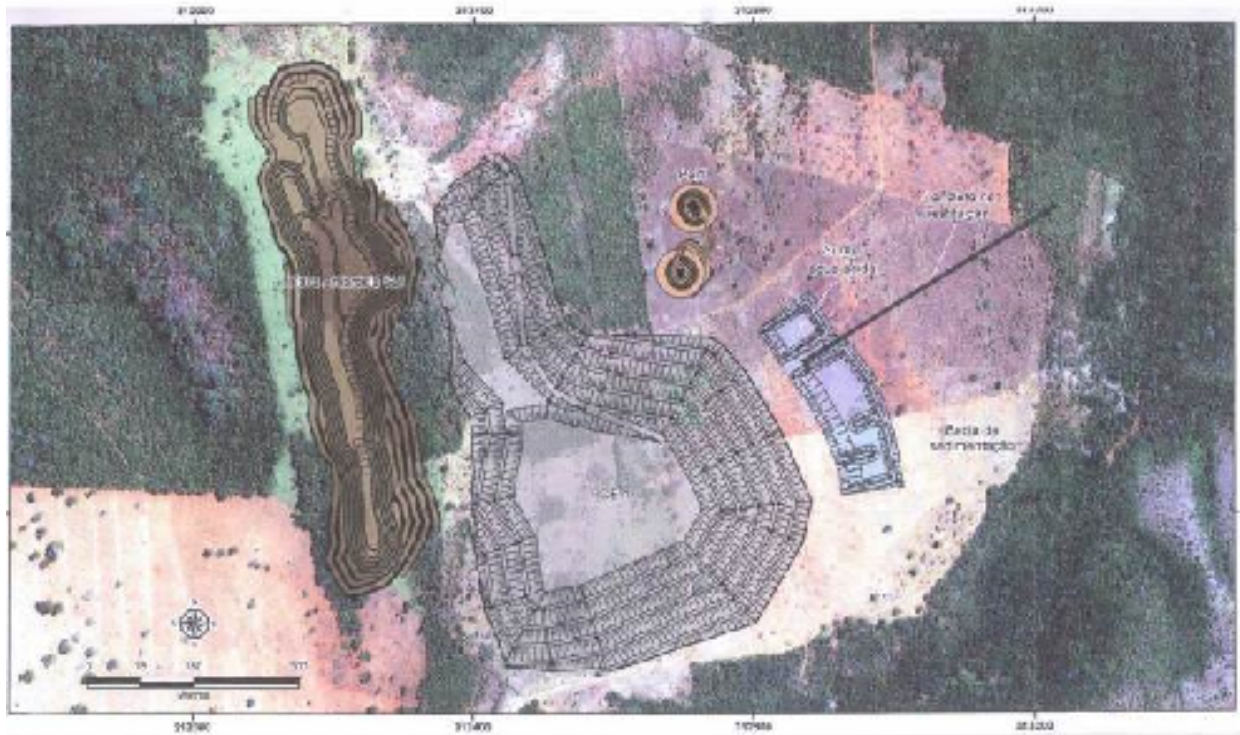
Layout geral da Mina de Ambrósia Sul. Fonte: Plano Conceitual de Fechamento da Mina (2015).
